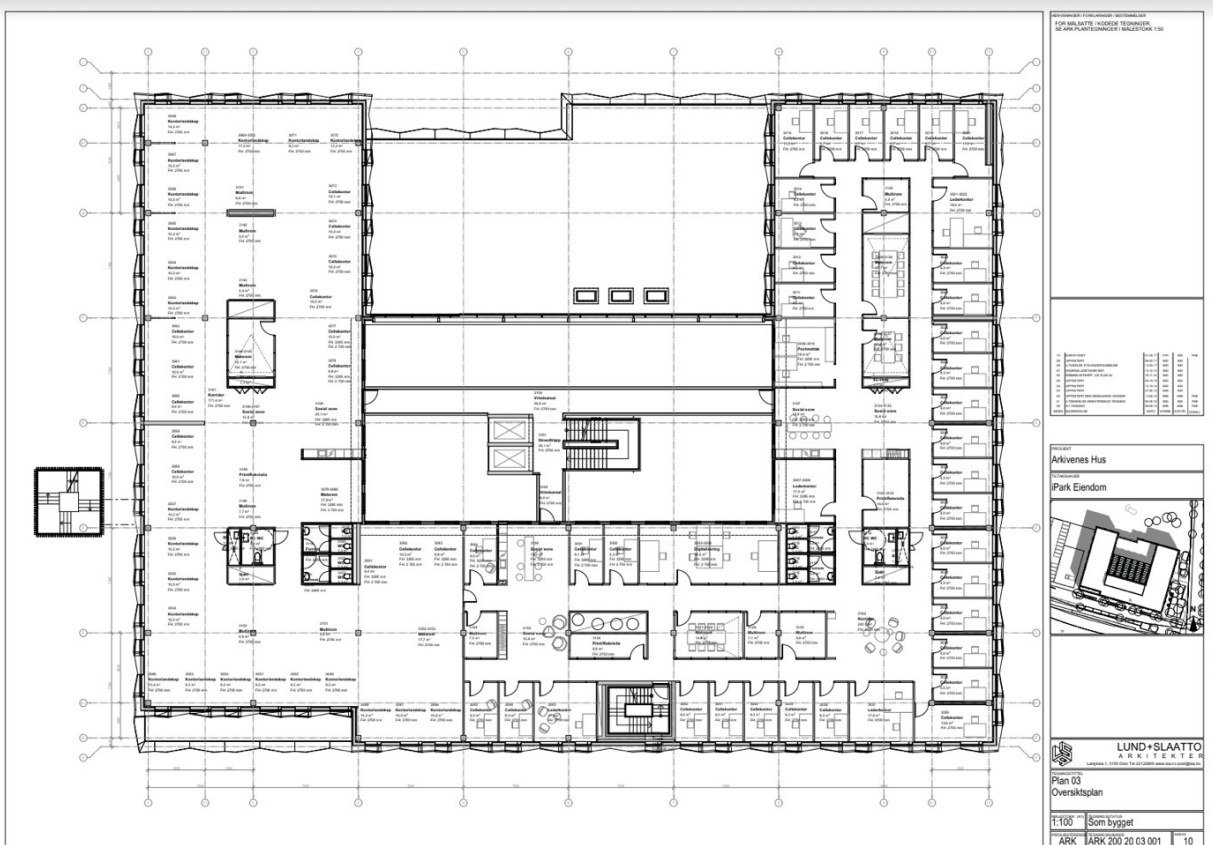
Plantegning plan 1. (Lund+Slaatto Arkitekter, u.d.)
